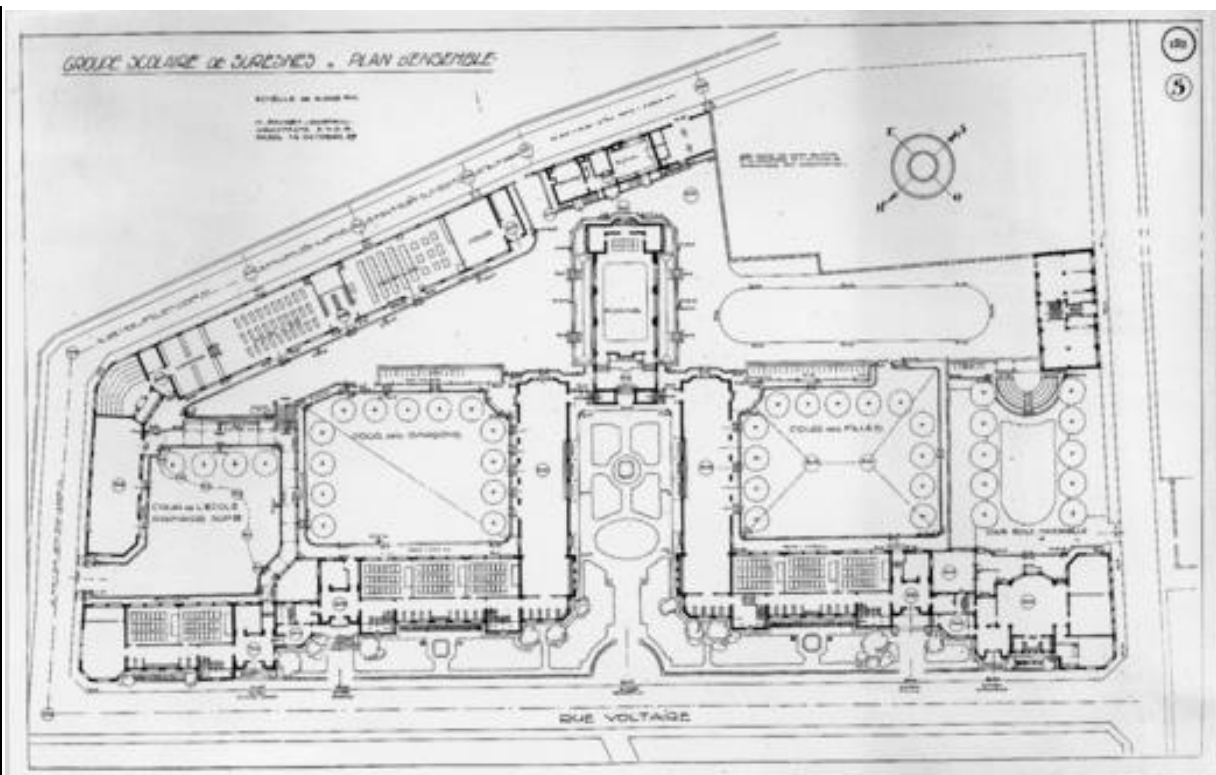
Groupe scolaire de la rue Voltaire, Suresnes, Maurice Payret-Dortail, architecte, 1925. Plan du rez-de-chaussée du groupe scolaire. AM de Suresnes série M.
